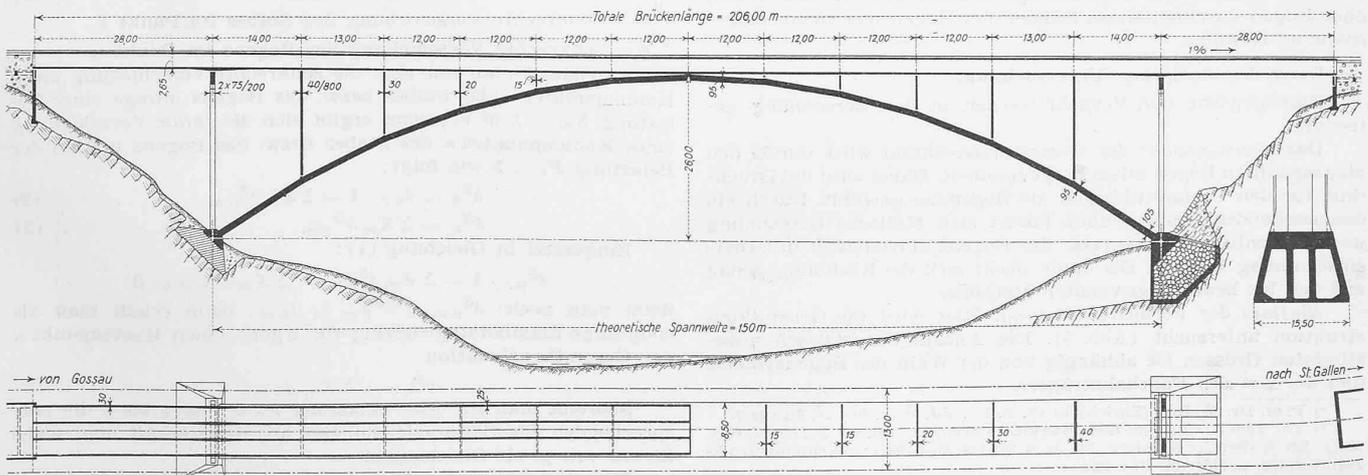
Grundriss und Längsschnitt des Wettbewerb-Entwurfes für eine neue Kräzernbrücke bei St. Gallen. — Masstab 1 : 1100.
